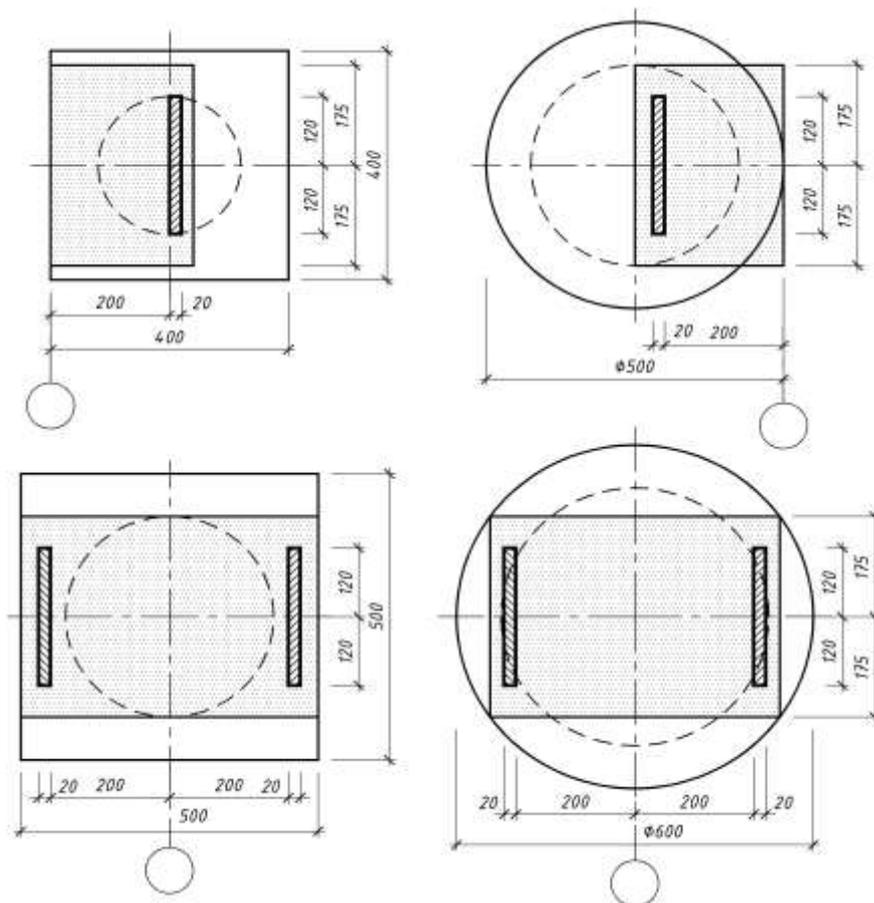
Расположение опорных ребер стальных стропильных конструкций на оголовках колонн
